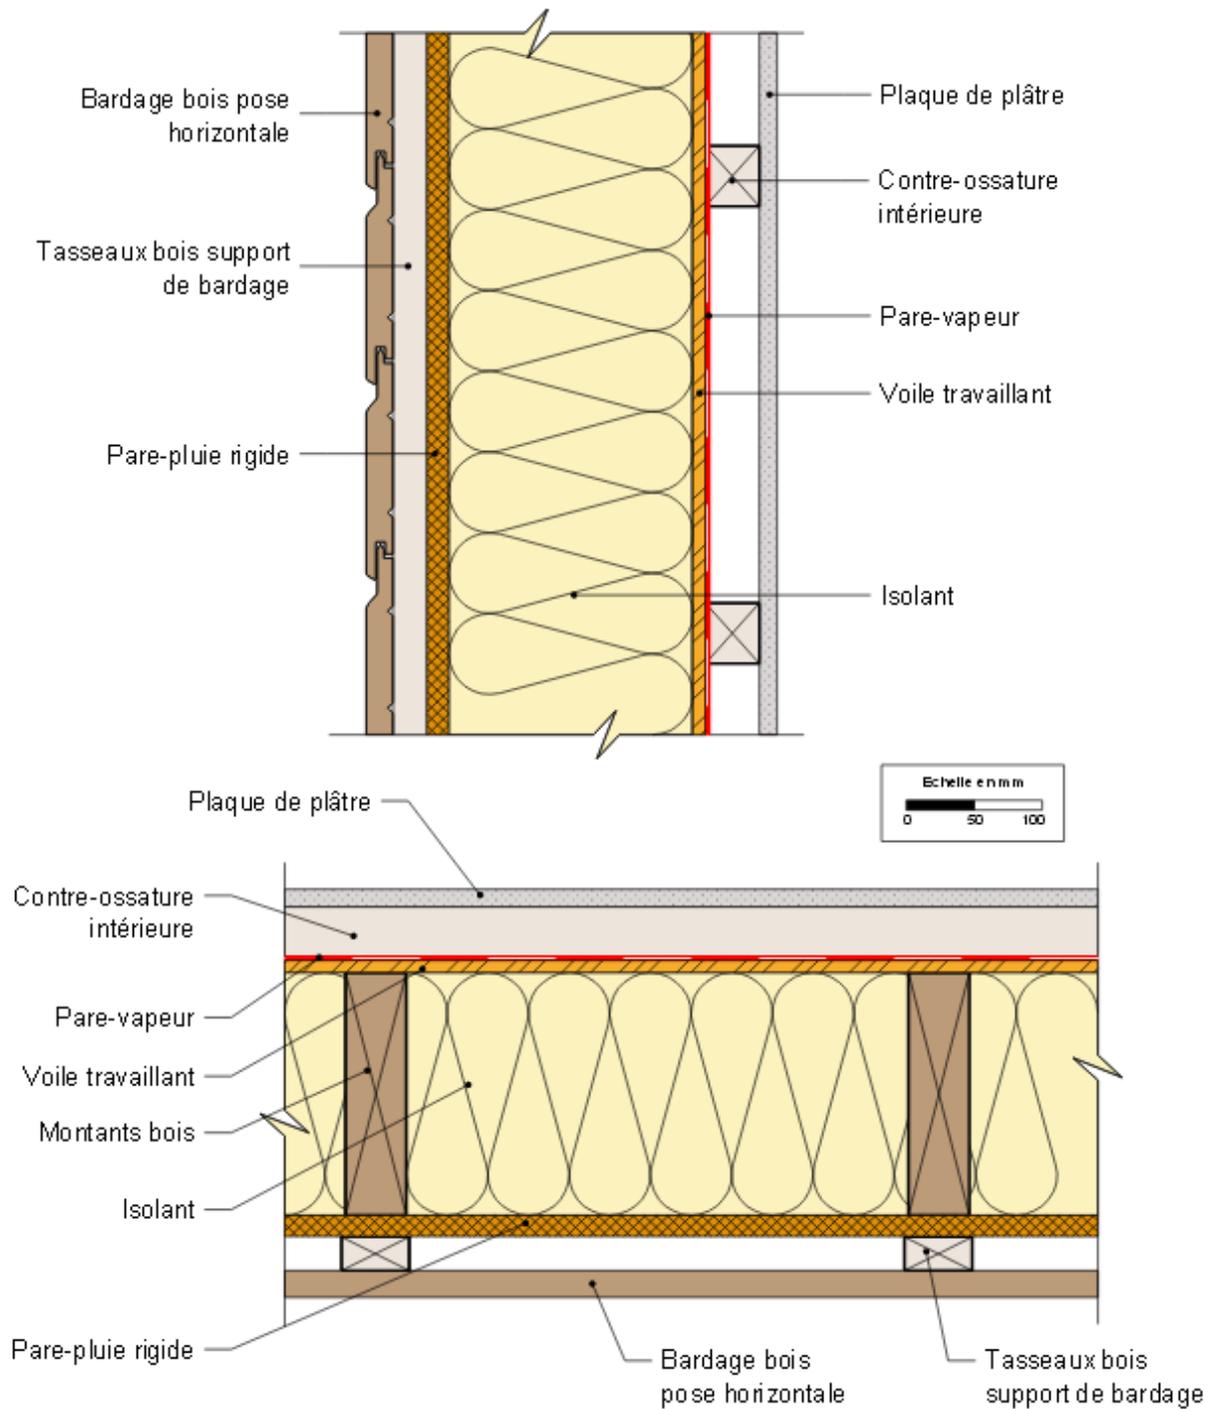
Contreventement intérieur avec écran rigide en fibre de bois et pare-vapeur souple (coupe verticale en haut, verticale en bas)
